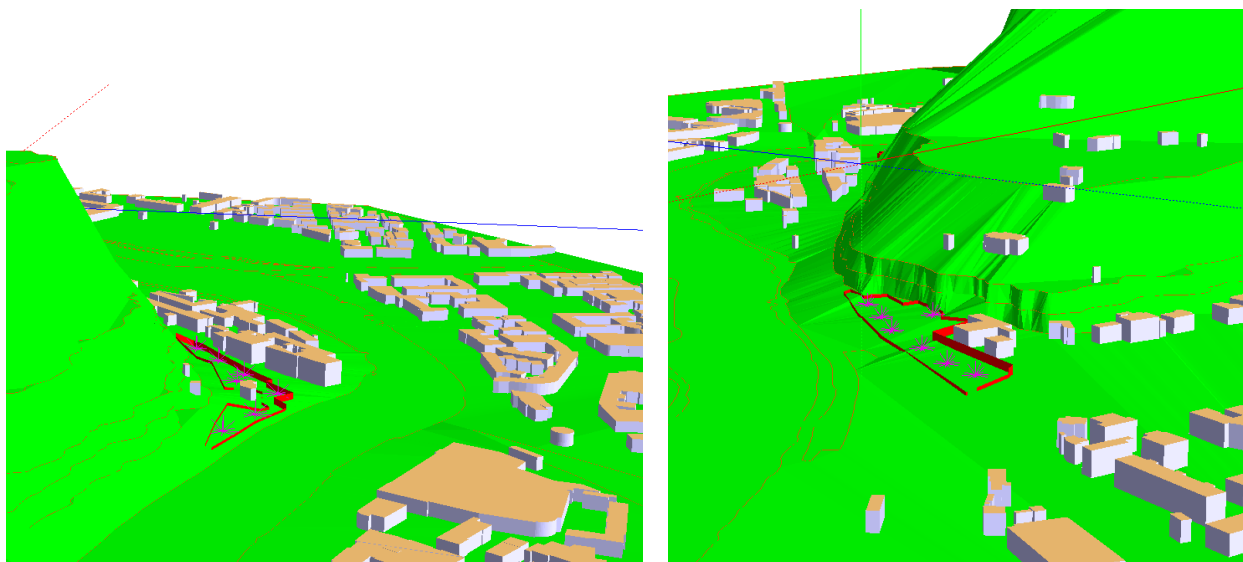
Modellazione tridimensionale in SoundPlan - in rosso le barriere e recinzioni di cantiere
